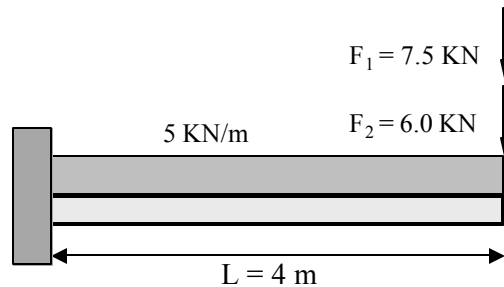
Sección longitudinal de la viga de concreto reforzado (Ejemplo 2).
